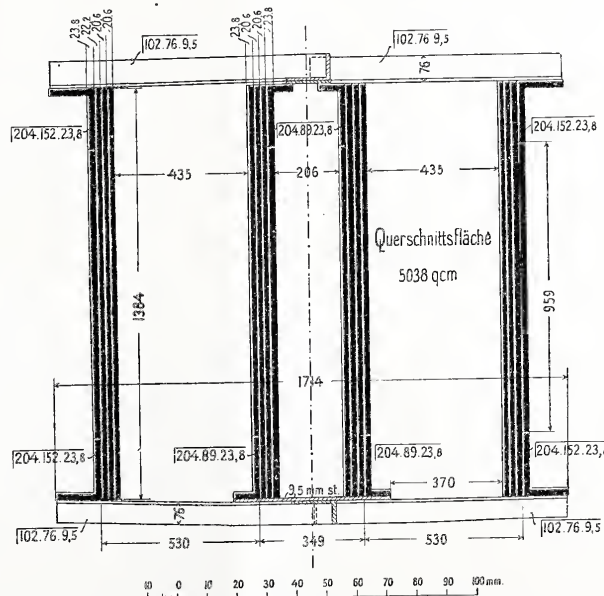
Querschnitt des Untergurtgliedes A₉ der Quebecbrücke. (Maße in Millimetern.)
